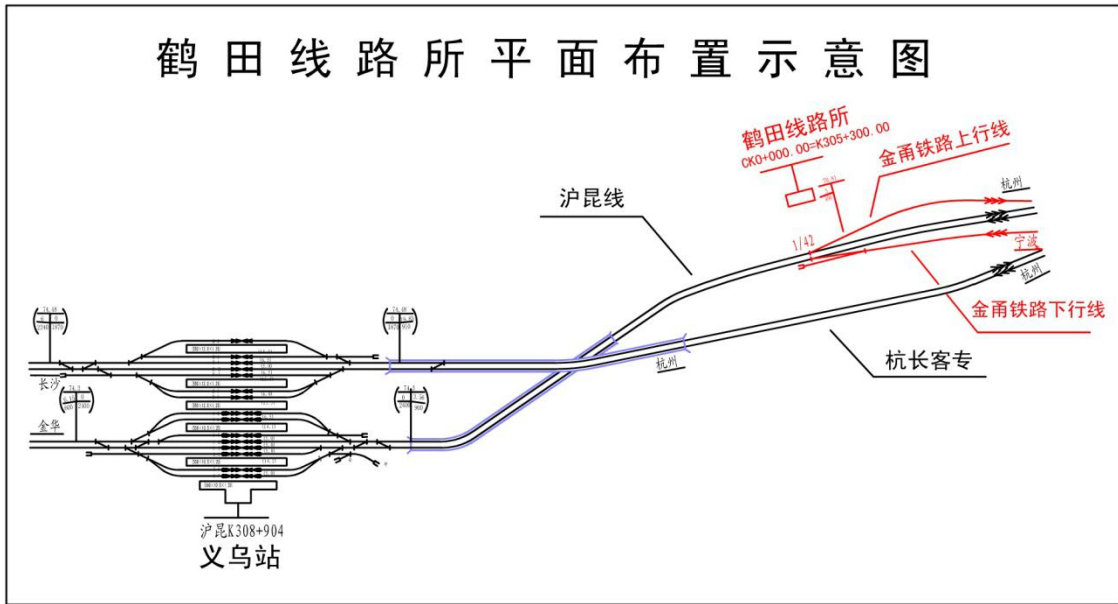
义乌站、鹤田线路所平面布置示意图
